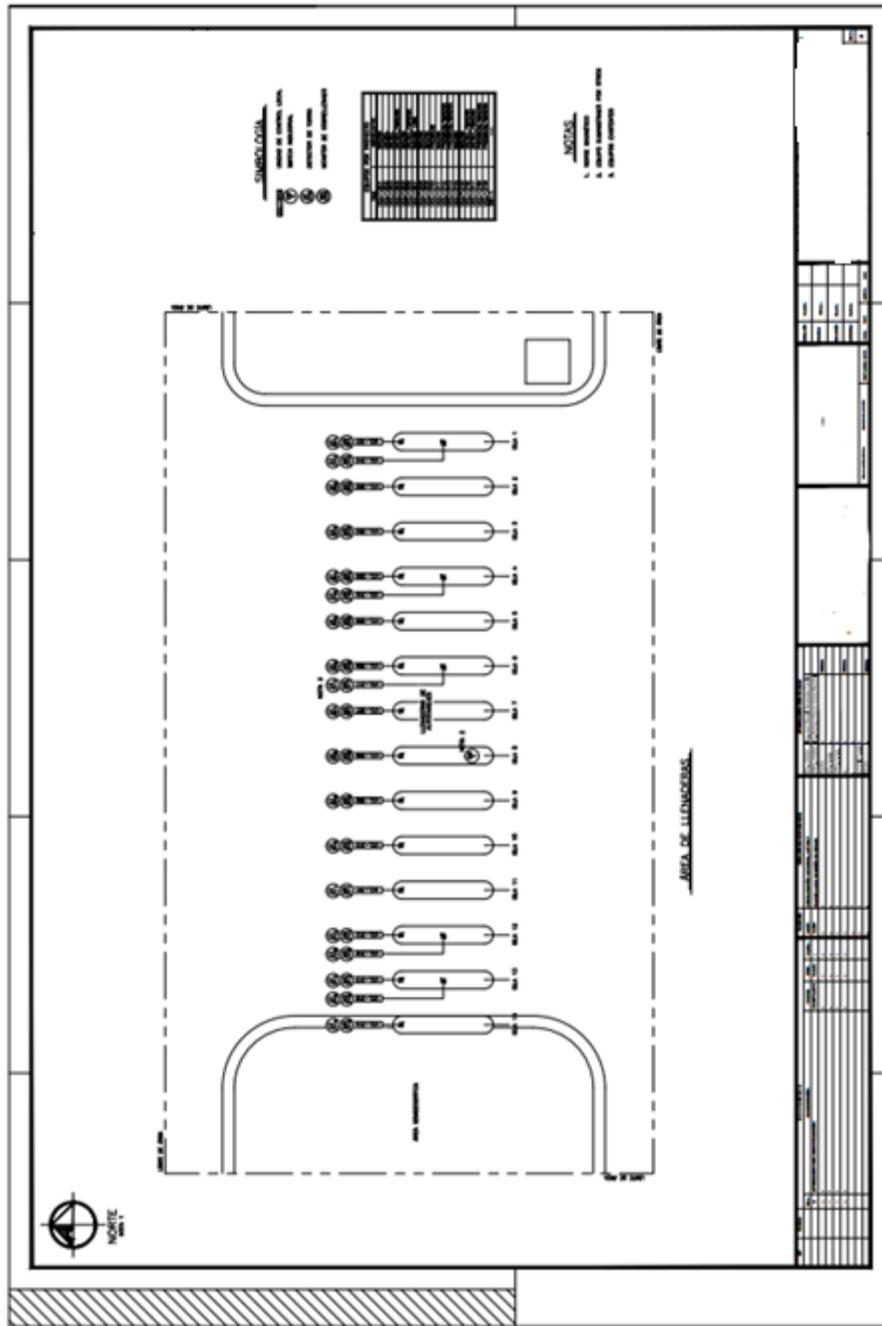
Plano De Localización De Llenaderas (fuente: IIESA plano B-004).
